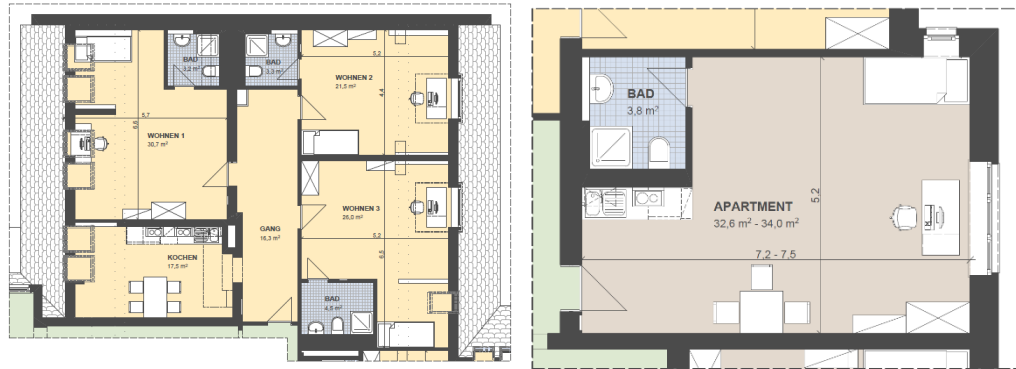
links: Grundriss 3er-WG, rechts: Grundriss Appartement [16]
